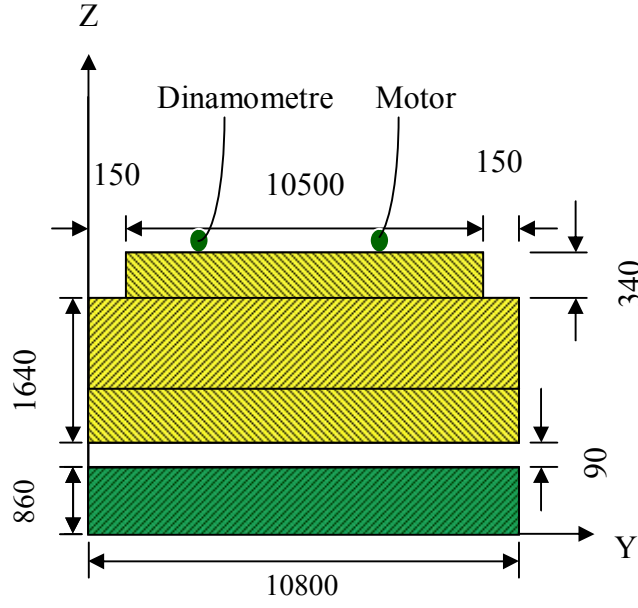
Test yatağı enine kesit görünüşü B – B enkesiti
